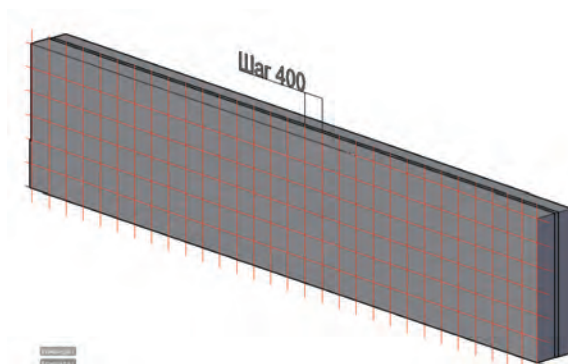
Схема армирования трехслойной стеновой плиты в подвале здания
